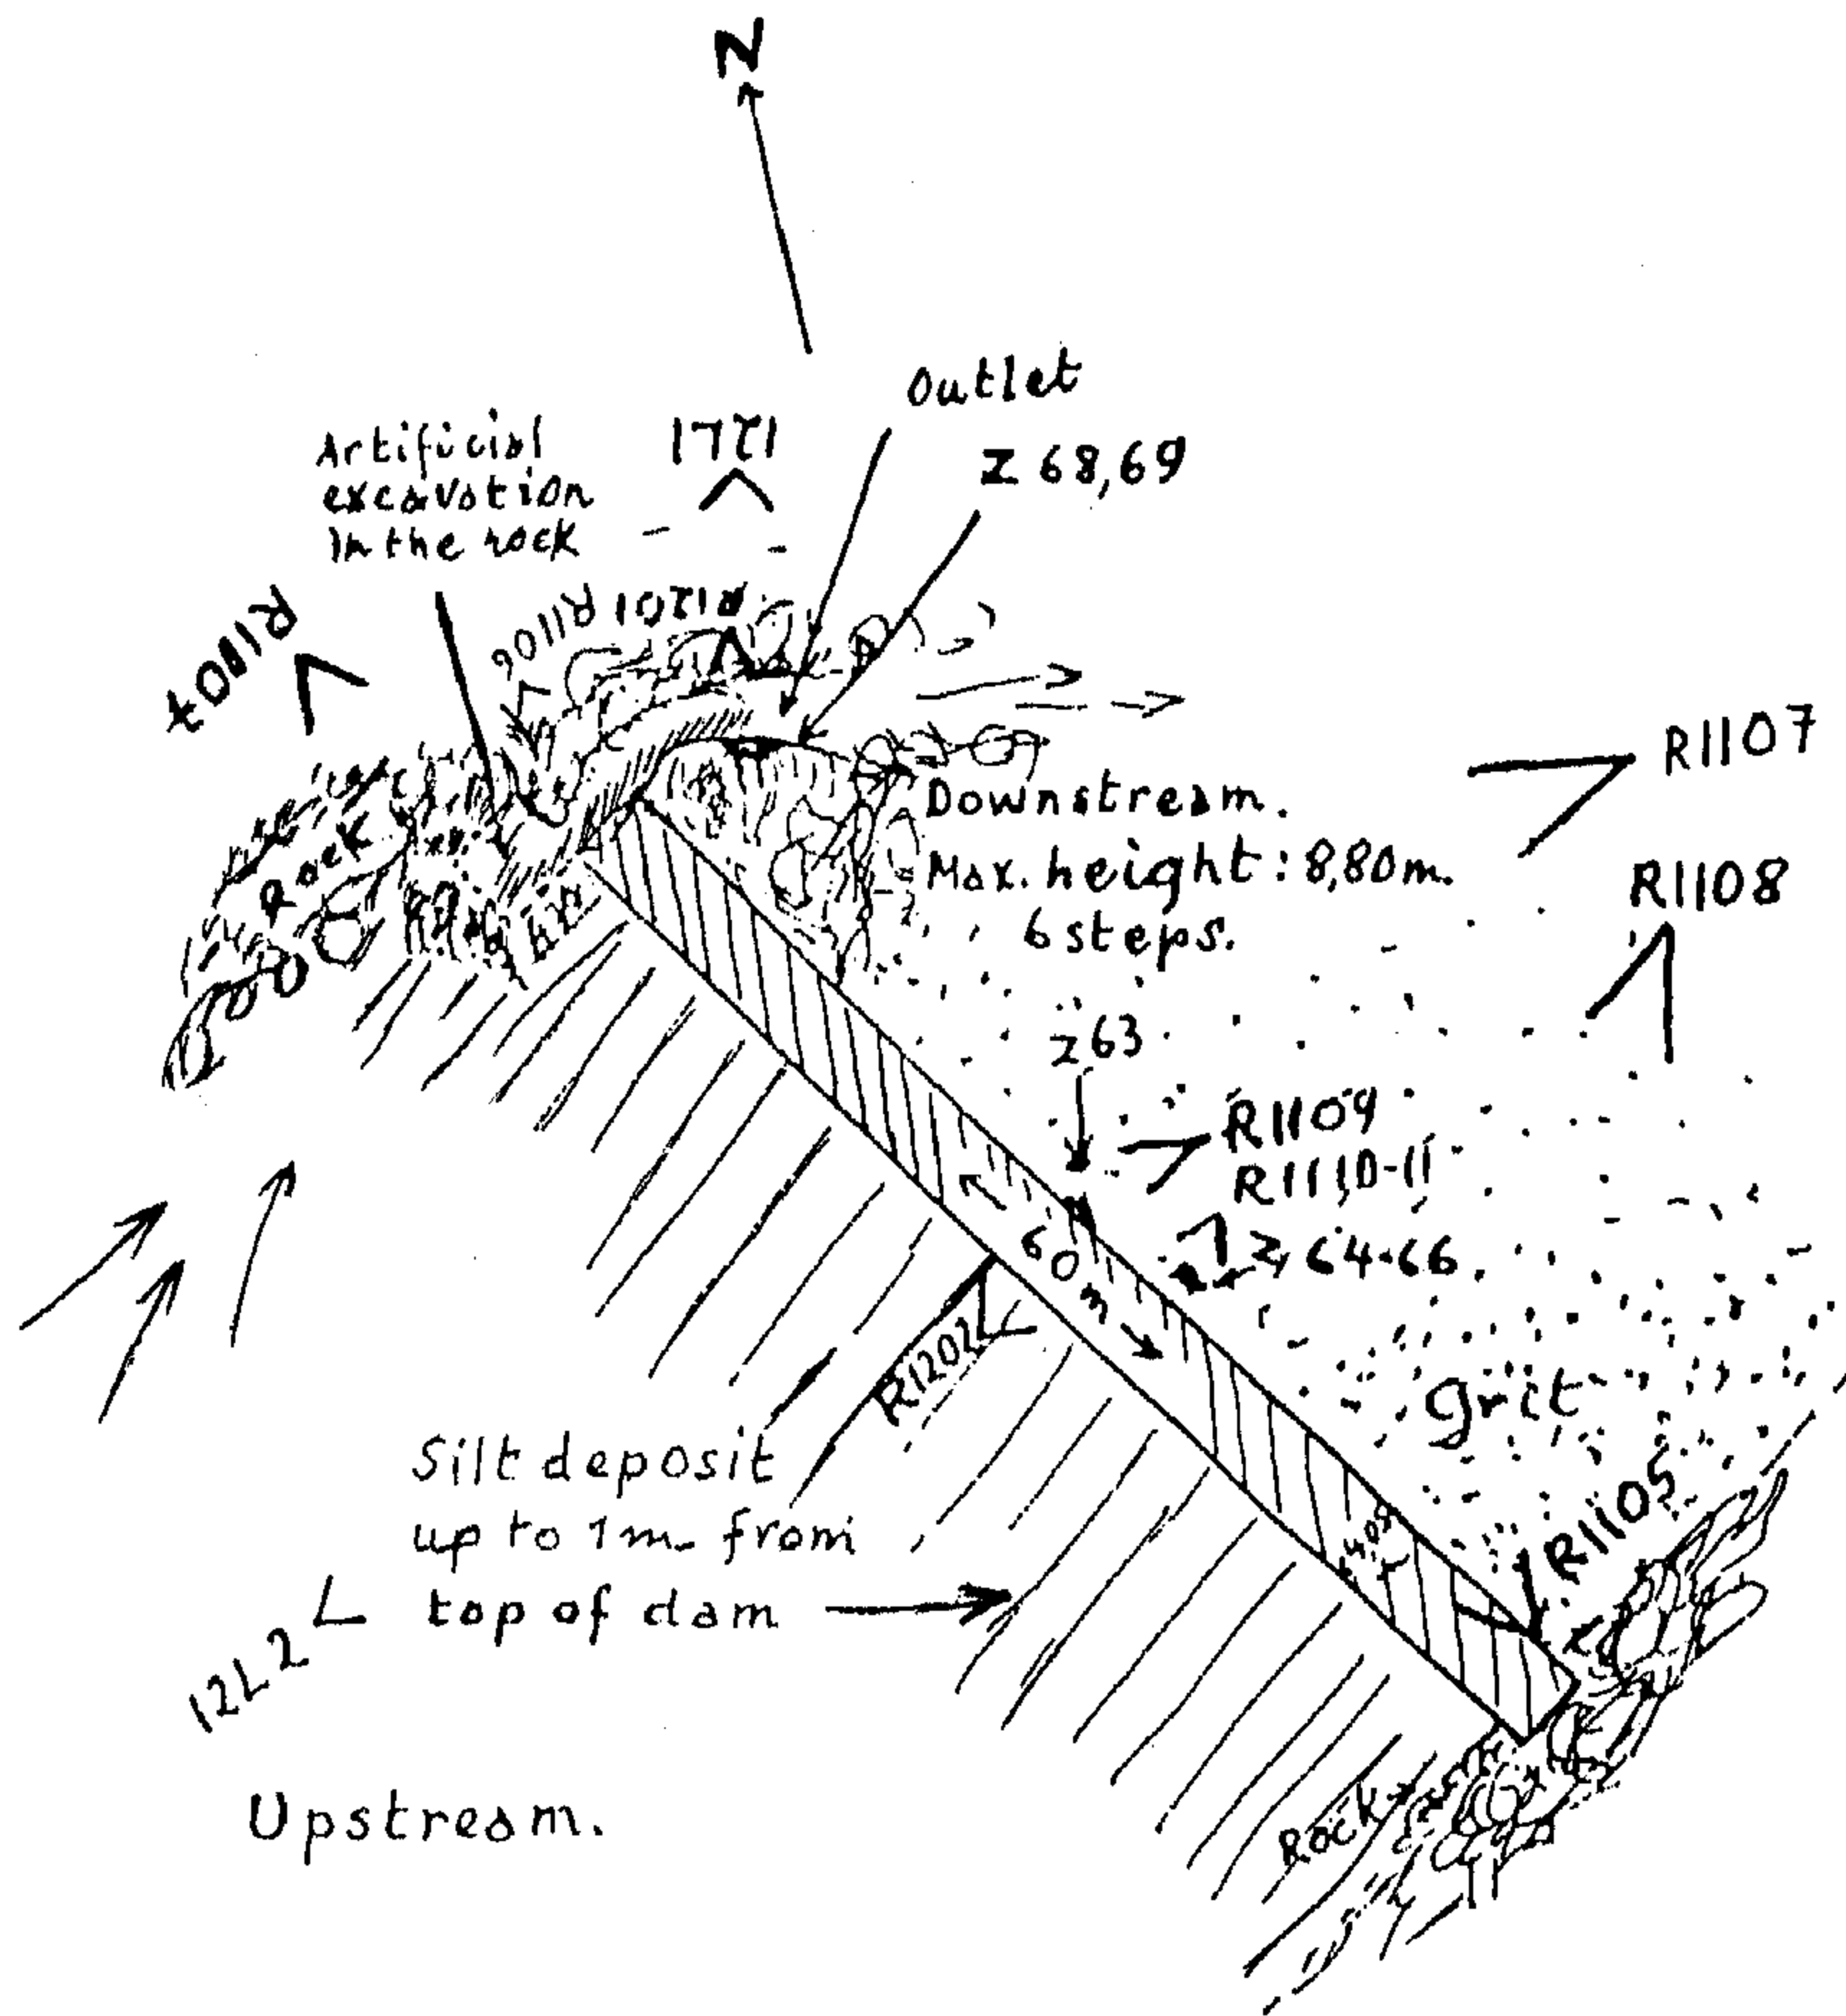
مسقط أفقي لسد السملقي ، كما رسمته البعثة الأوربية المكونة من فليبي
